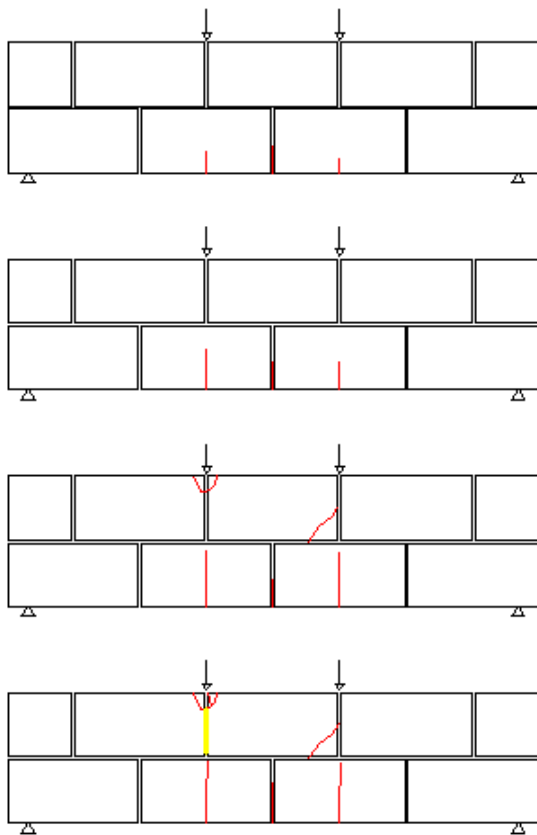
Mapeamento das fissuras VCE-2.
